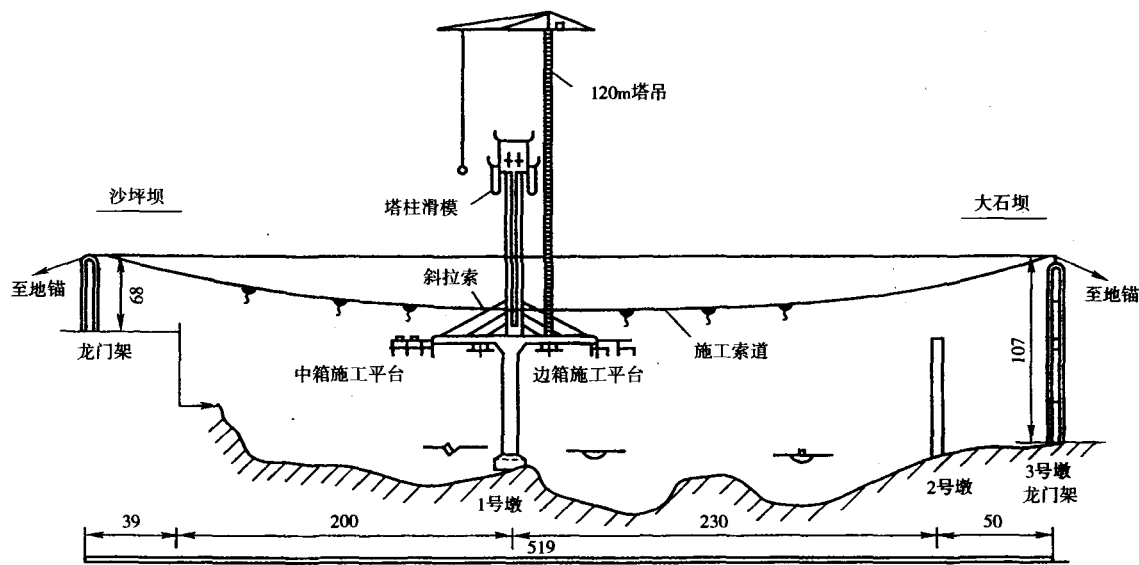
重庆石门桥悬索吊布置图 (尺寸单位:m)
